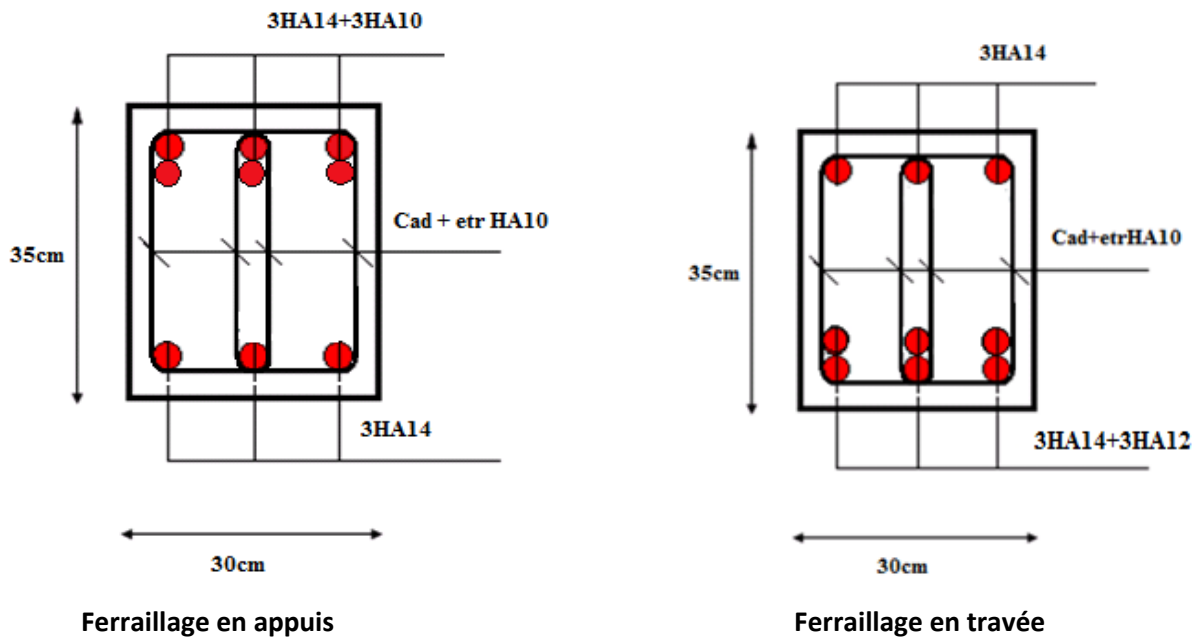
Ferrailage de la poutre palière (RDC)
